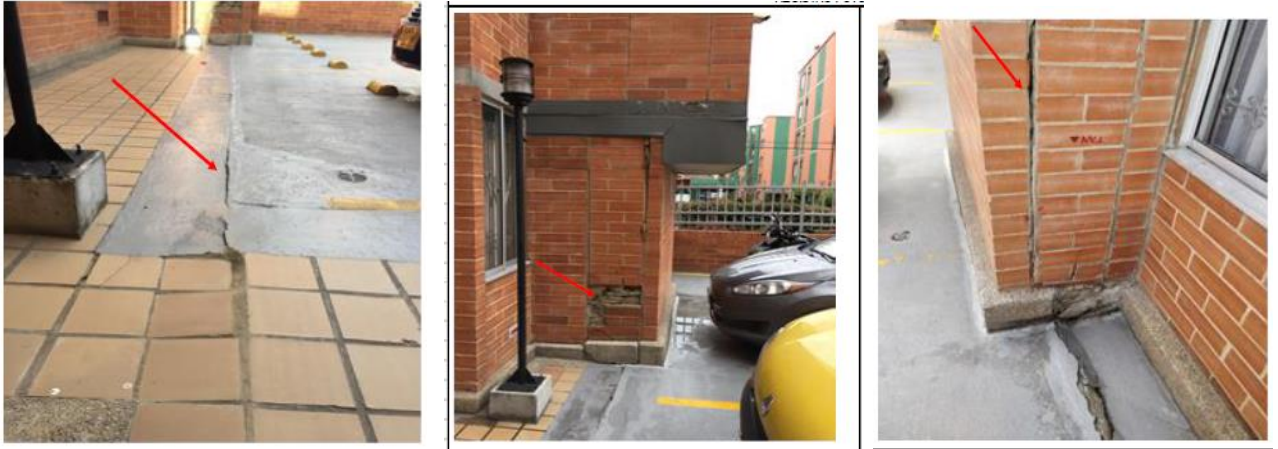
Localización de lesiones en muros intervenidos (Fisuras, Grietas y Desprendimientos)
